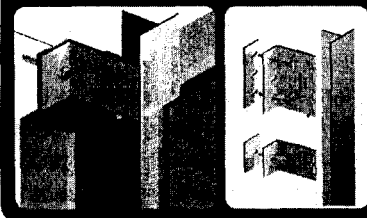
Алюминиевая облицовка вентилируемого фасада
